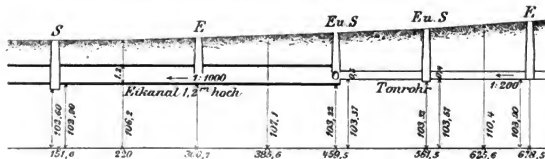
Höhenplan eines Straßenkanals. Längen 1 : 5000. Höhen 1 : 50.
